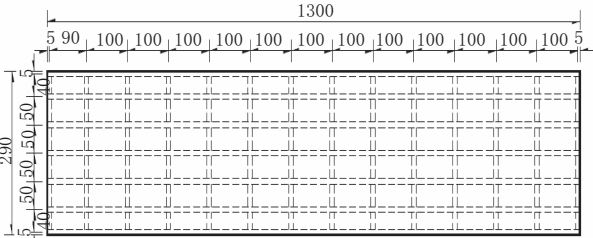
保通用 A 型钢结构盖板平面示意图(单位:mm)
